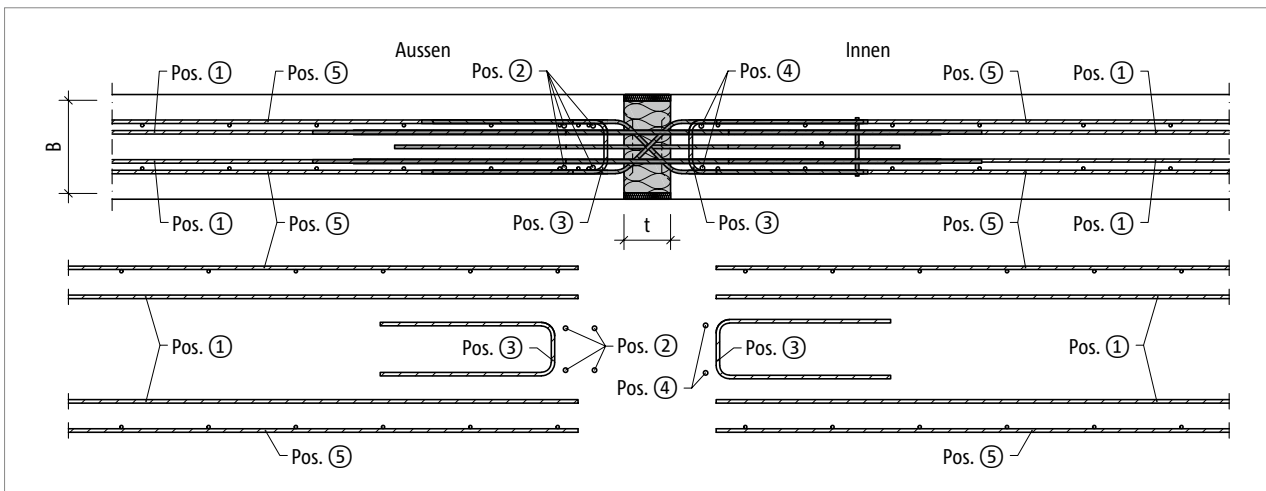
Schöck Isokorb® T Typ WL: Bauseitige Bewehrung; Grundriss
